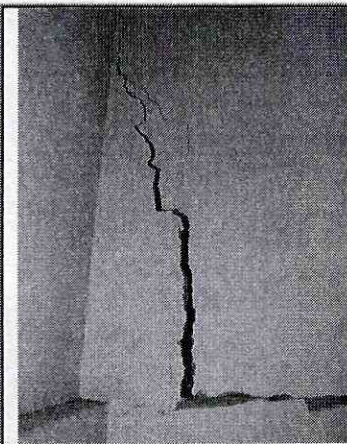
Grieta en muro de cerramiento del costado occidental del predio.
